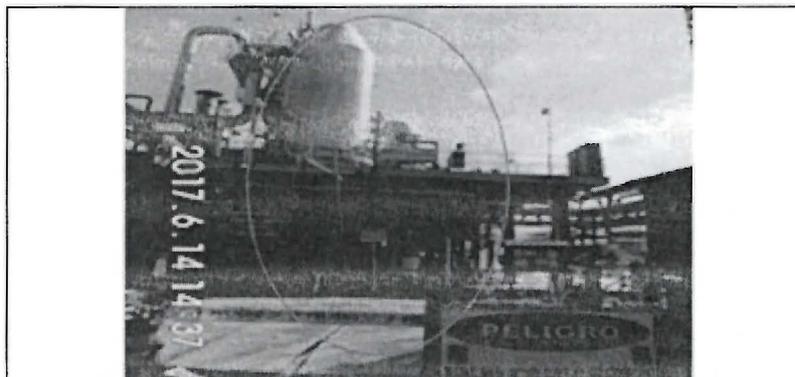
Trabajos de soldadura para la instalación de estructuras metálicas en la planta de producción de azúcar de caña que viene siendo instalada por el administrado.
